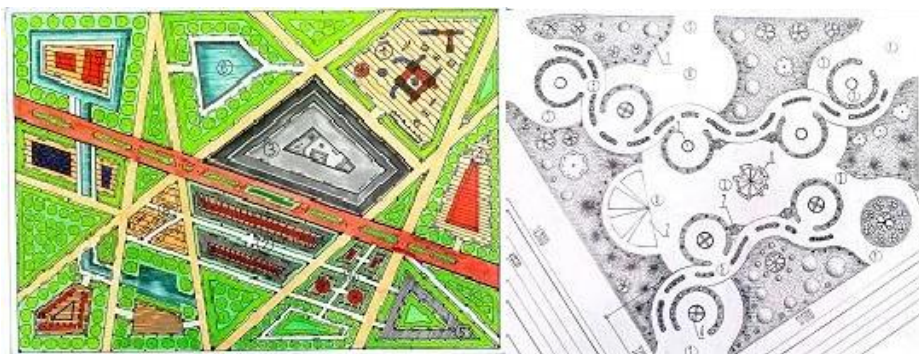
Пример выполнения эскиза генерального плана детской площадки,
